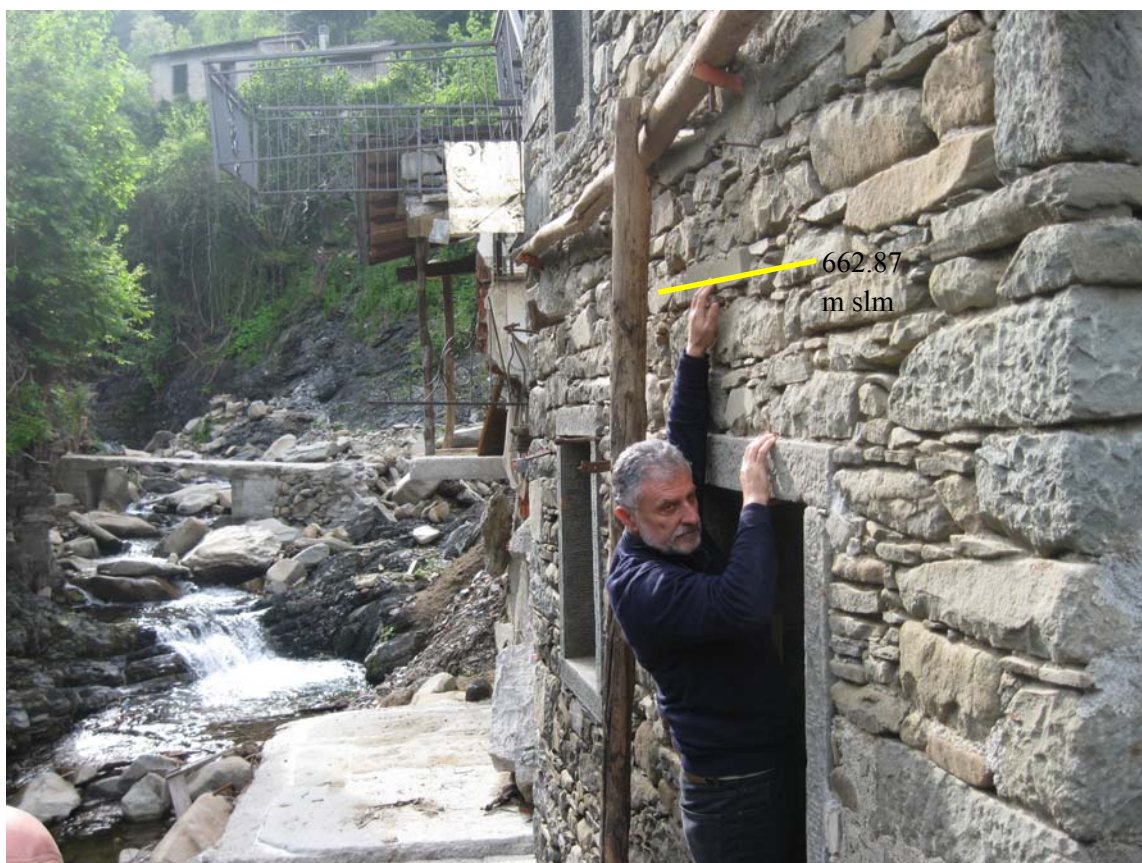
5 Traccia tra sezione 13 e sezione 14 (FOTO 4 in planimetria TGL 1.2)
